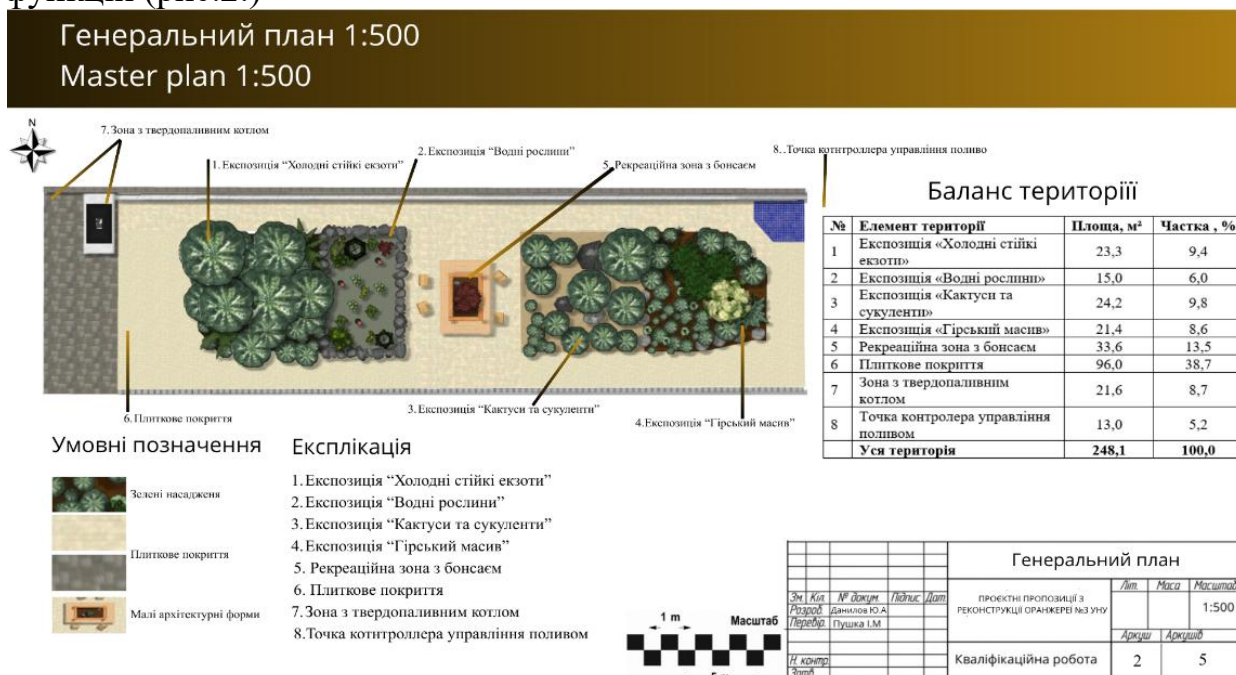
Генеральний план реконструкції оранжереї № 3 УНУ
